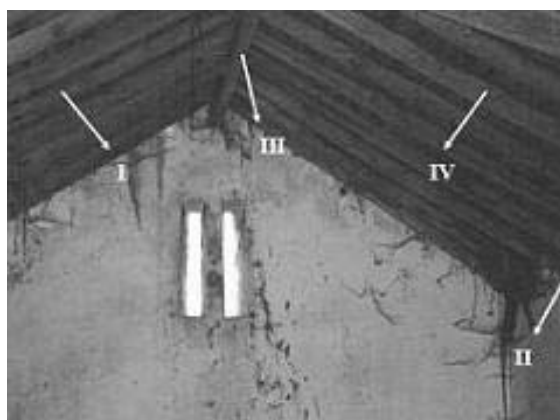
Soluções da cobertura em vigas de madeira (imagem: A. Murta)
